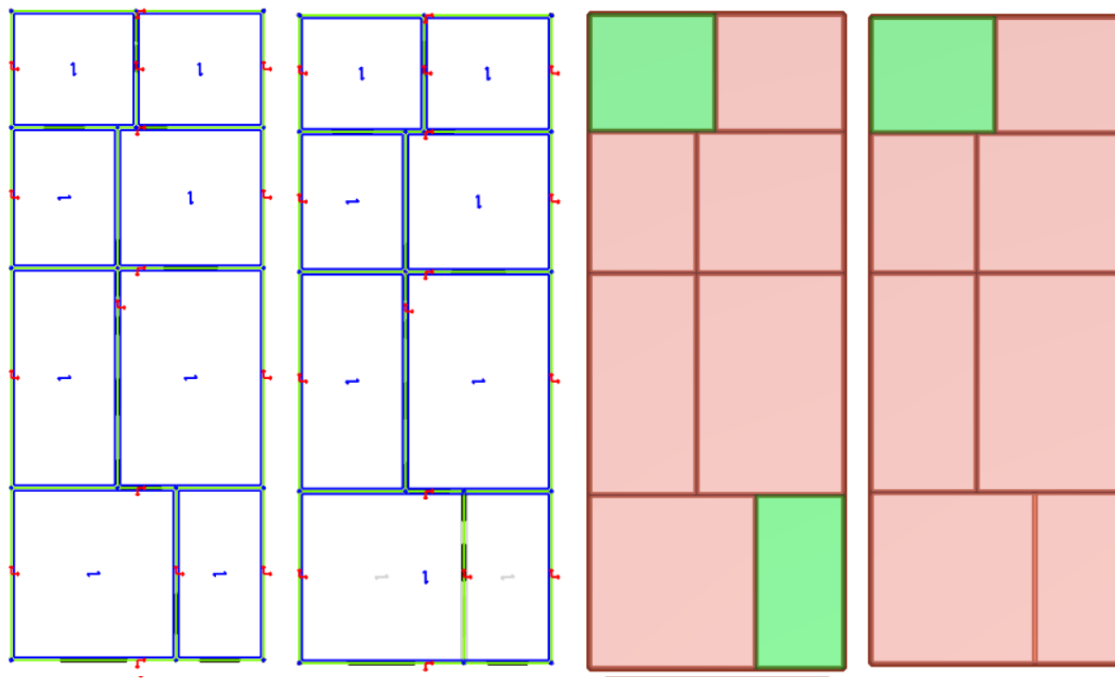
Modelo de edificación de área media implementado en 3Muri. A la izquierda vista en planta de la distribución de carga en cada uno de los pisos y a la derecha modelo BIM en planta de la edificación.
